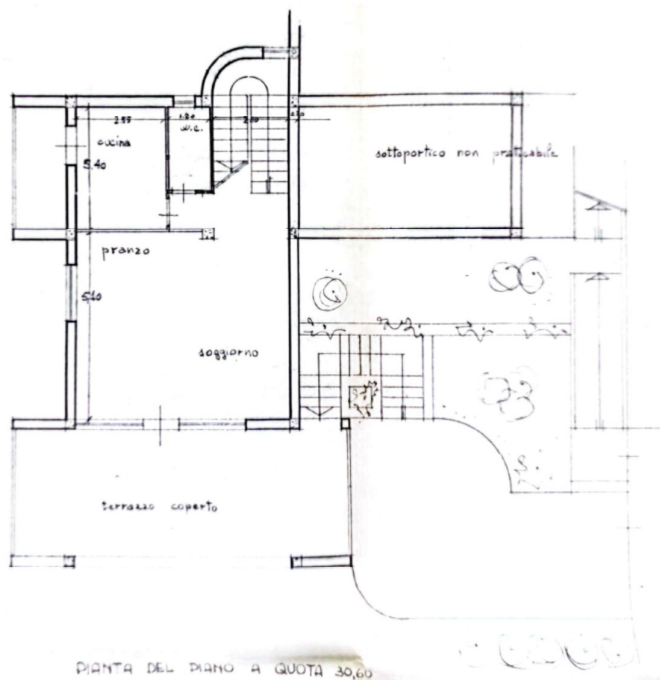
stralcio elaborato di progetto allegato al progetto in variante alla Licenza edilizia n. 615 del 22/036/1978
